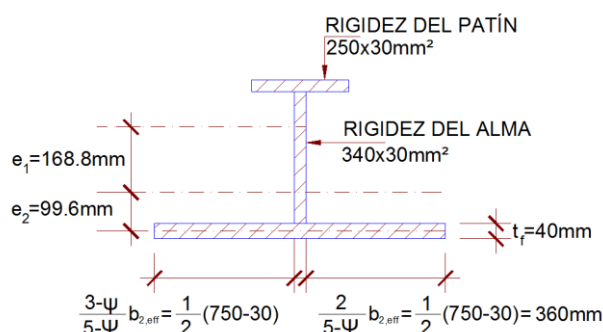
Sección transversal de la columna (Fuente: Elaboración propia).
